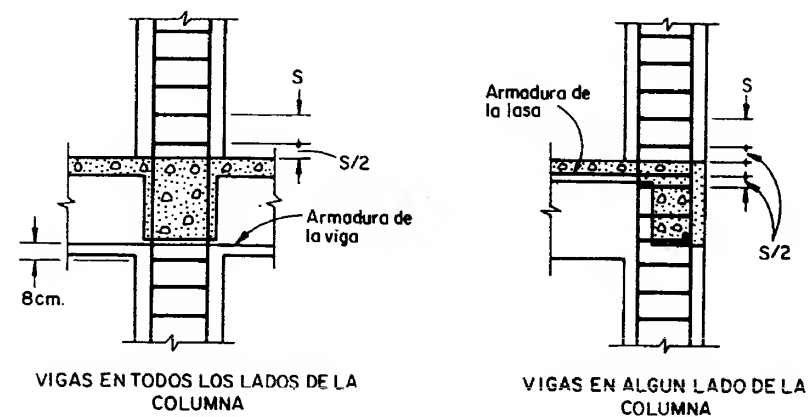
ARMADURA TRANSVERSAL EN COLUMNAS
